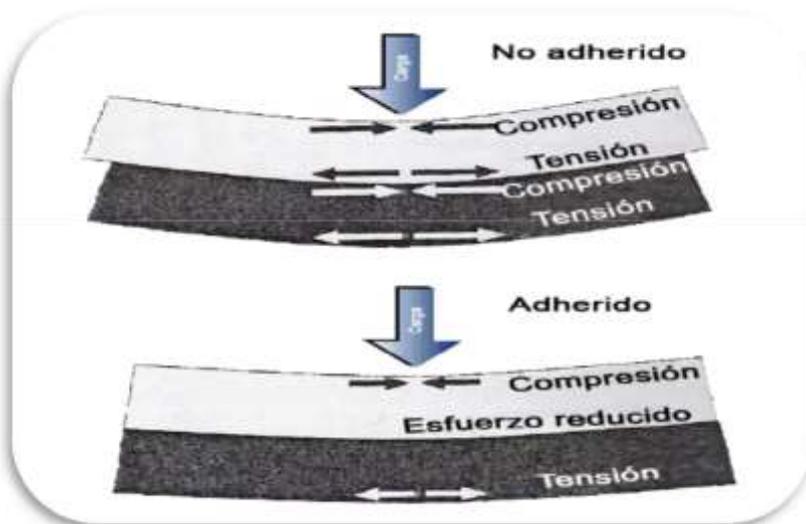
El Whitetopping, que idealmente es adherido, reduce los esfuerzos, gracias a la adherencia entre las capas de hormigón y de asfalto.
